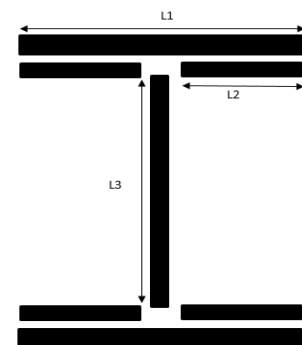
Assemblage soudé poutres -platine.
